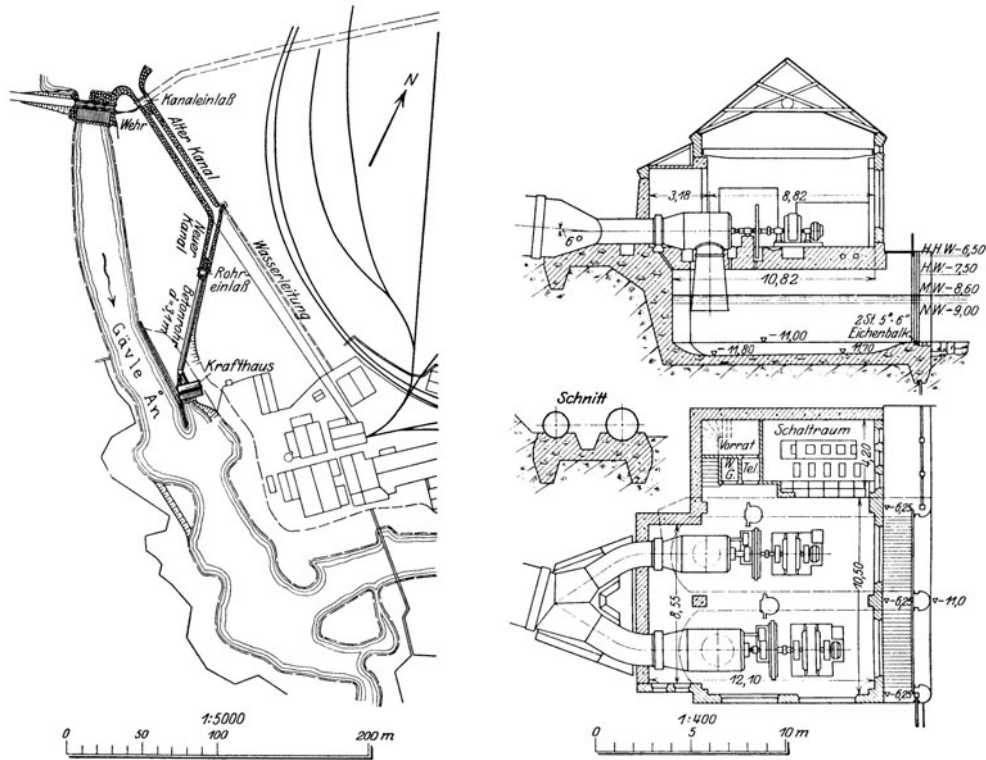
W. A. Mackmyra. Lageplan, Grundriß und Schnitt. (Verw.)
